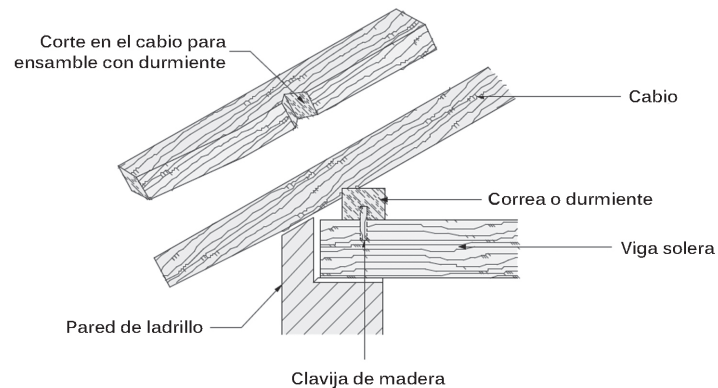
Detalle de ensamble de cabio, viga de alero y solera mediante clavija.
